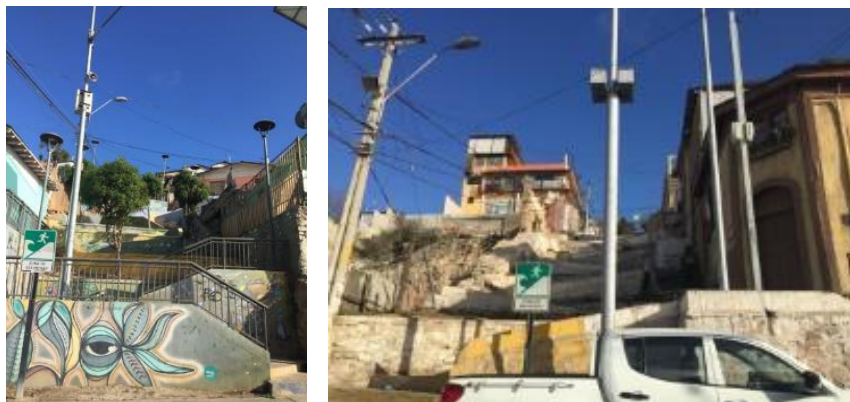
Zigzag calles Bilbao, Garriga. Fuente: Elaboración propia.
